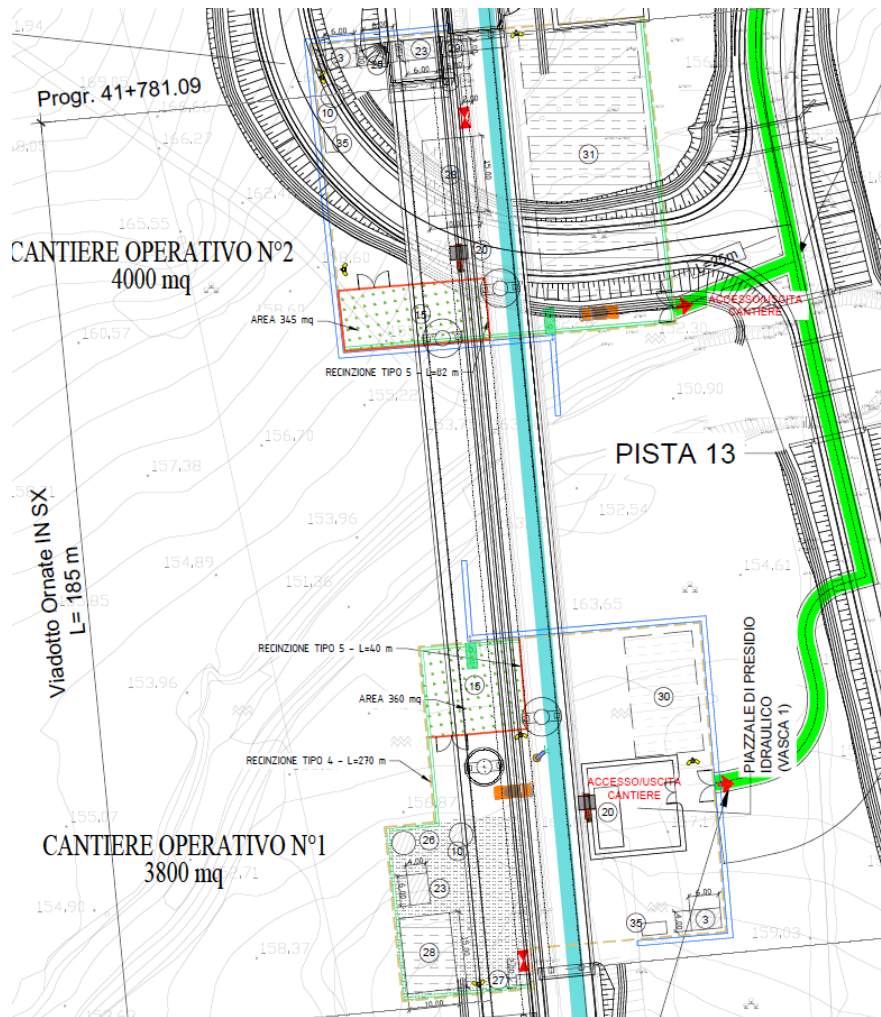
Planimetria cantiere operativo 1 e 2.
